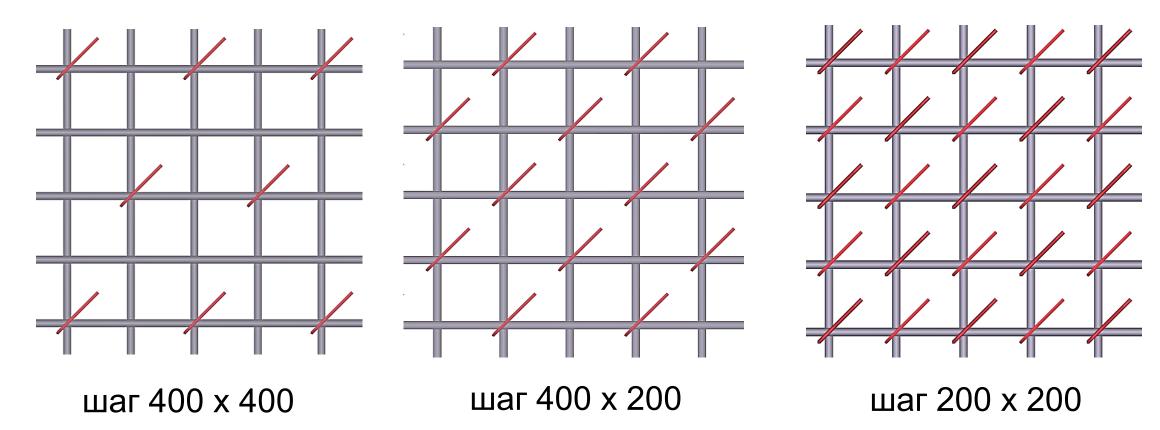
Поперечное армирование в плитах перекрытия и покрытия, см2/м2
